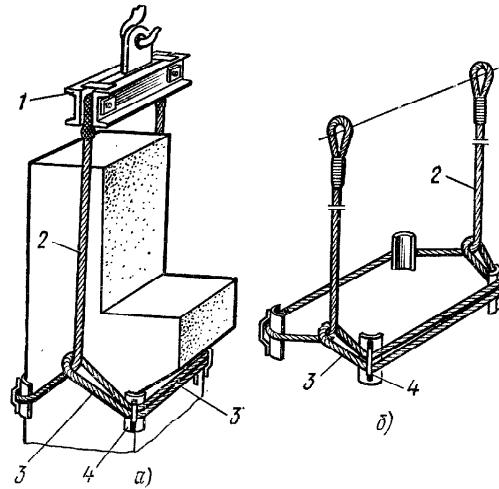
Подъем колонны траверсой (а) и схема строповки (б):
